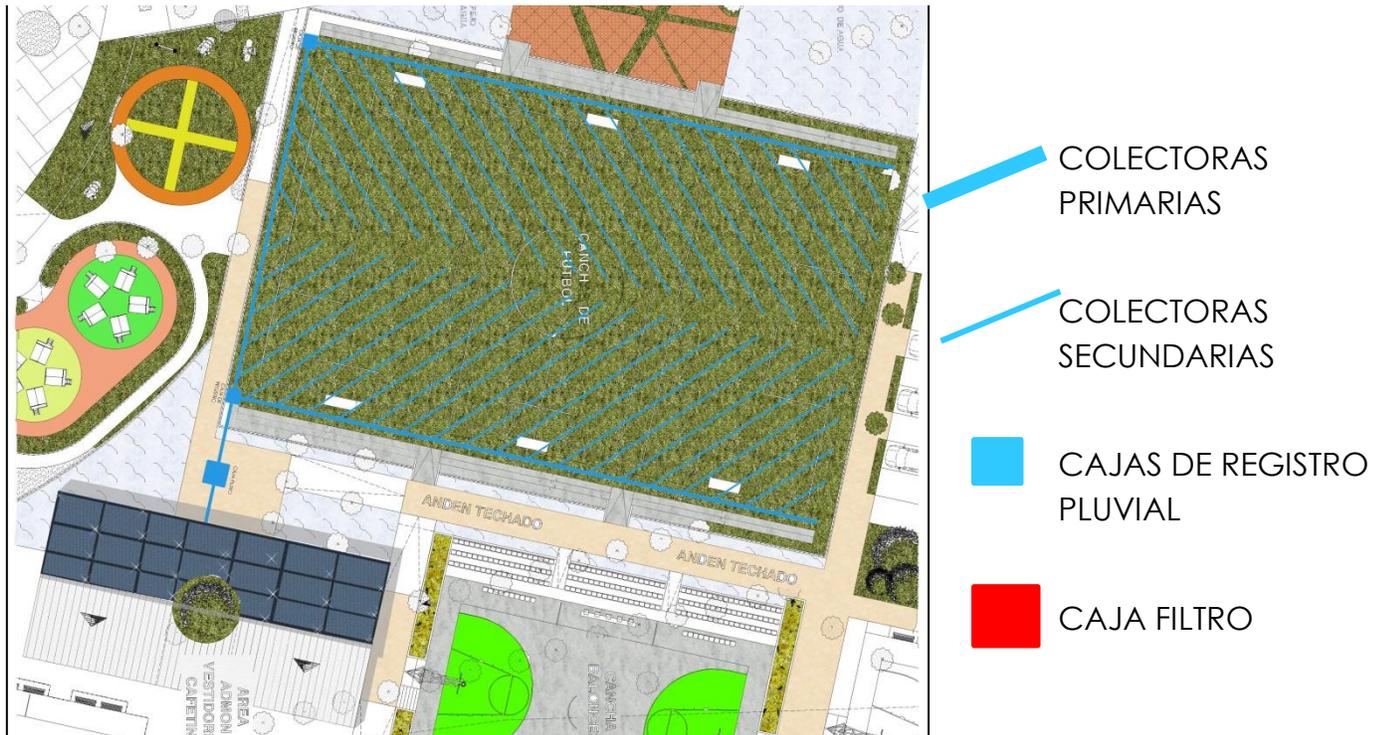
Vista en planta de esquema de drenaje pluvial de campo de fútbol
